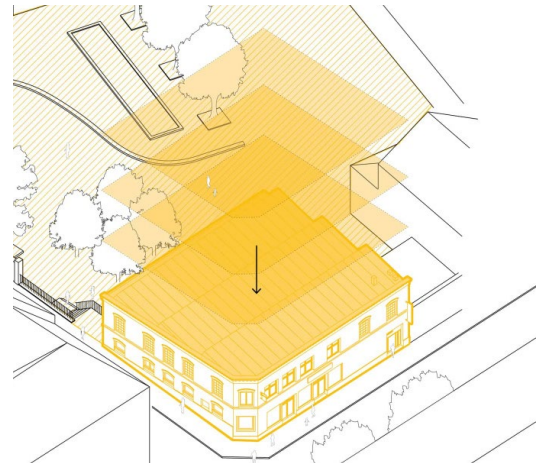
Urbane Situation Ecke Froweinstraße, Wiesenstraße – Schema der geplanten Erweiterung
